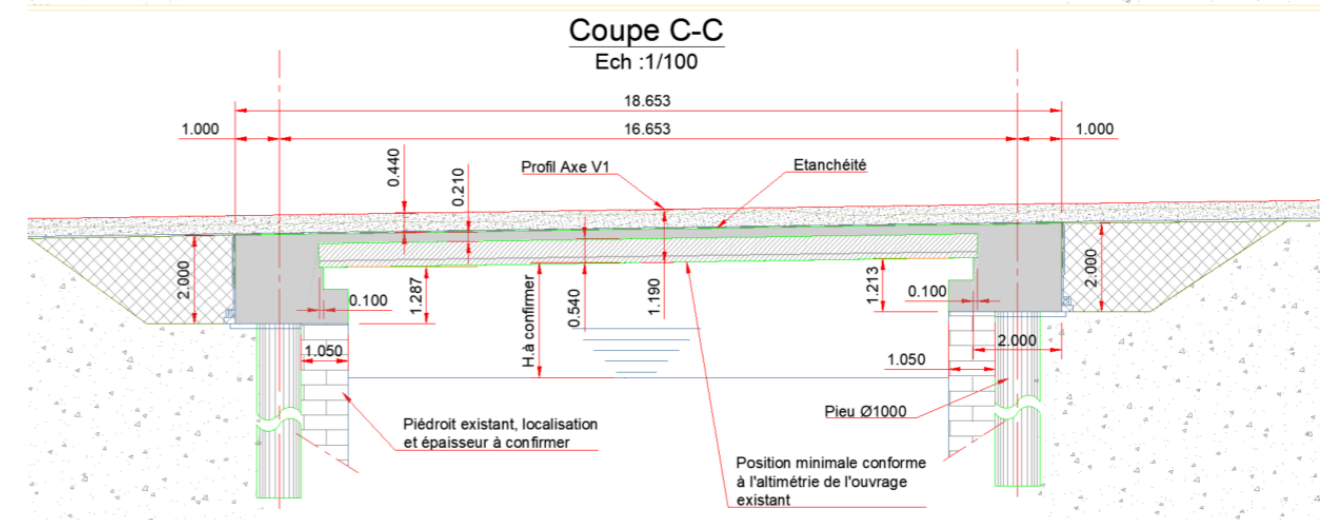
coupe longitudinale fonctionnelle sur ouvrage
